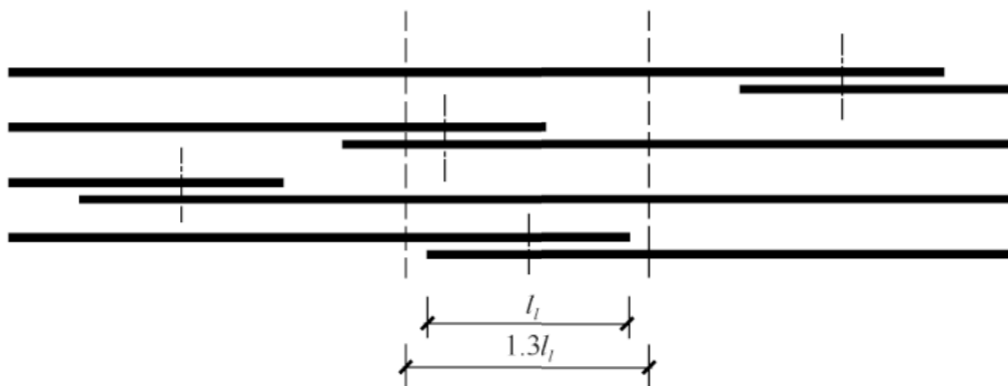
同一连接区段内纵向受拉钢筋的绑扎搭接接头
